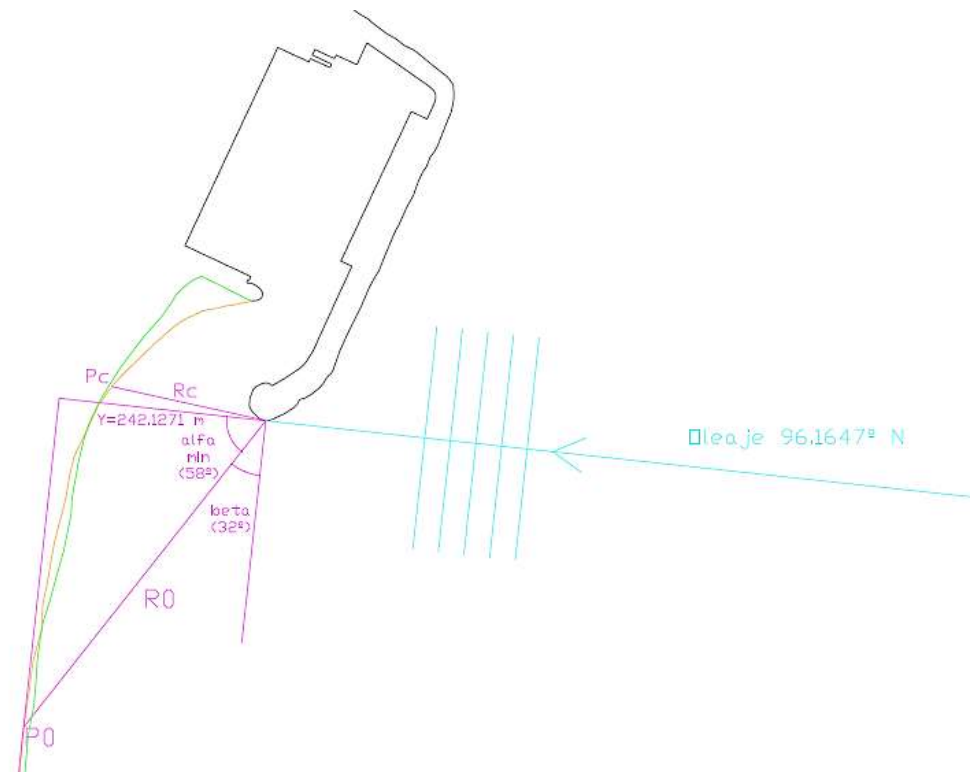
Parámetros de cálculo para la forma en planta de la playa.
